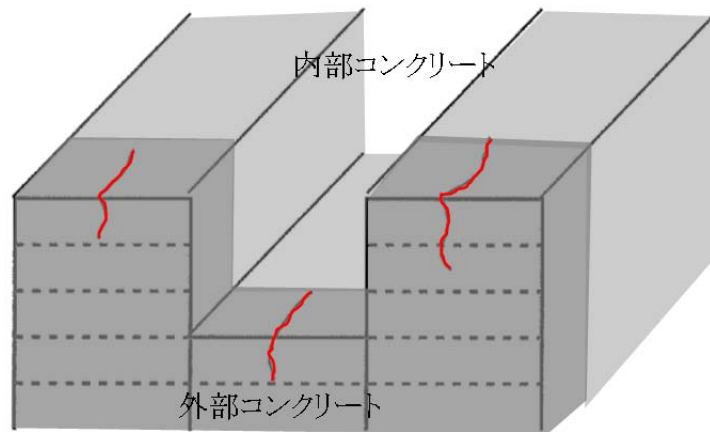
外部コンクリートに発生した鉛直ひび割れの例
